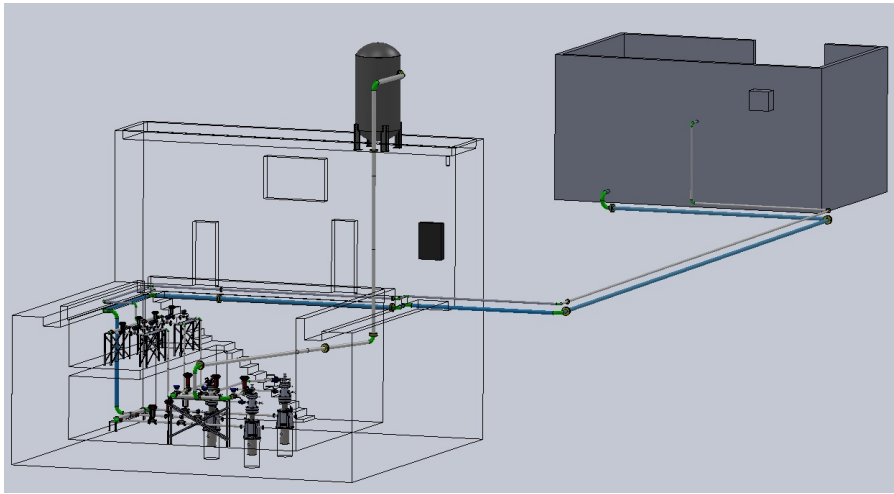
Esquemático da planta de elevação de fluidos do LACI.
